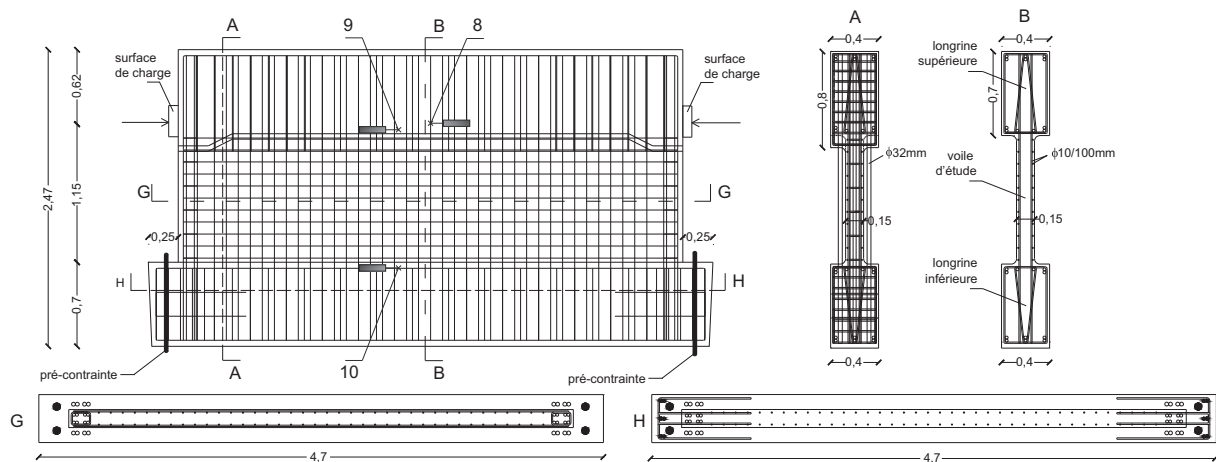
Dimensions du voile en béton armé du benchmark ConCrack [Rivillon et Gabs, 2011].
